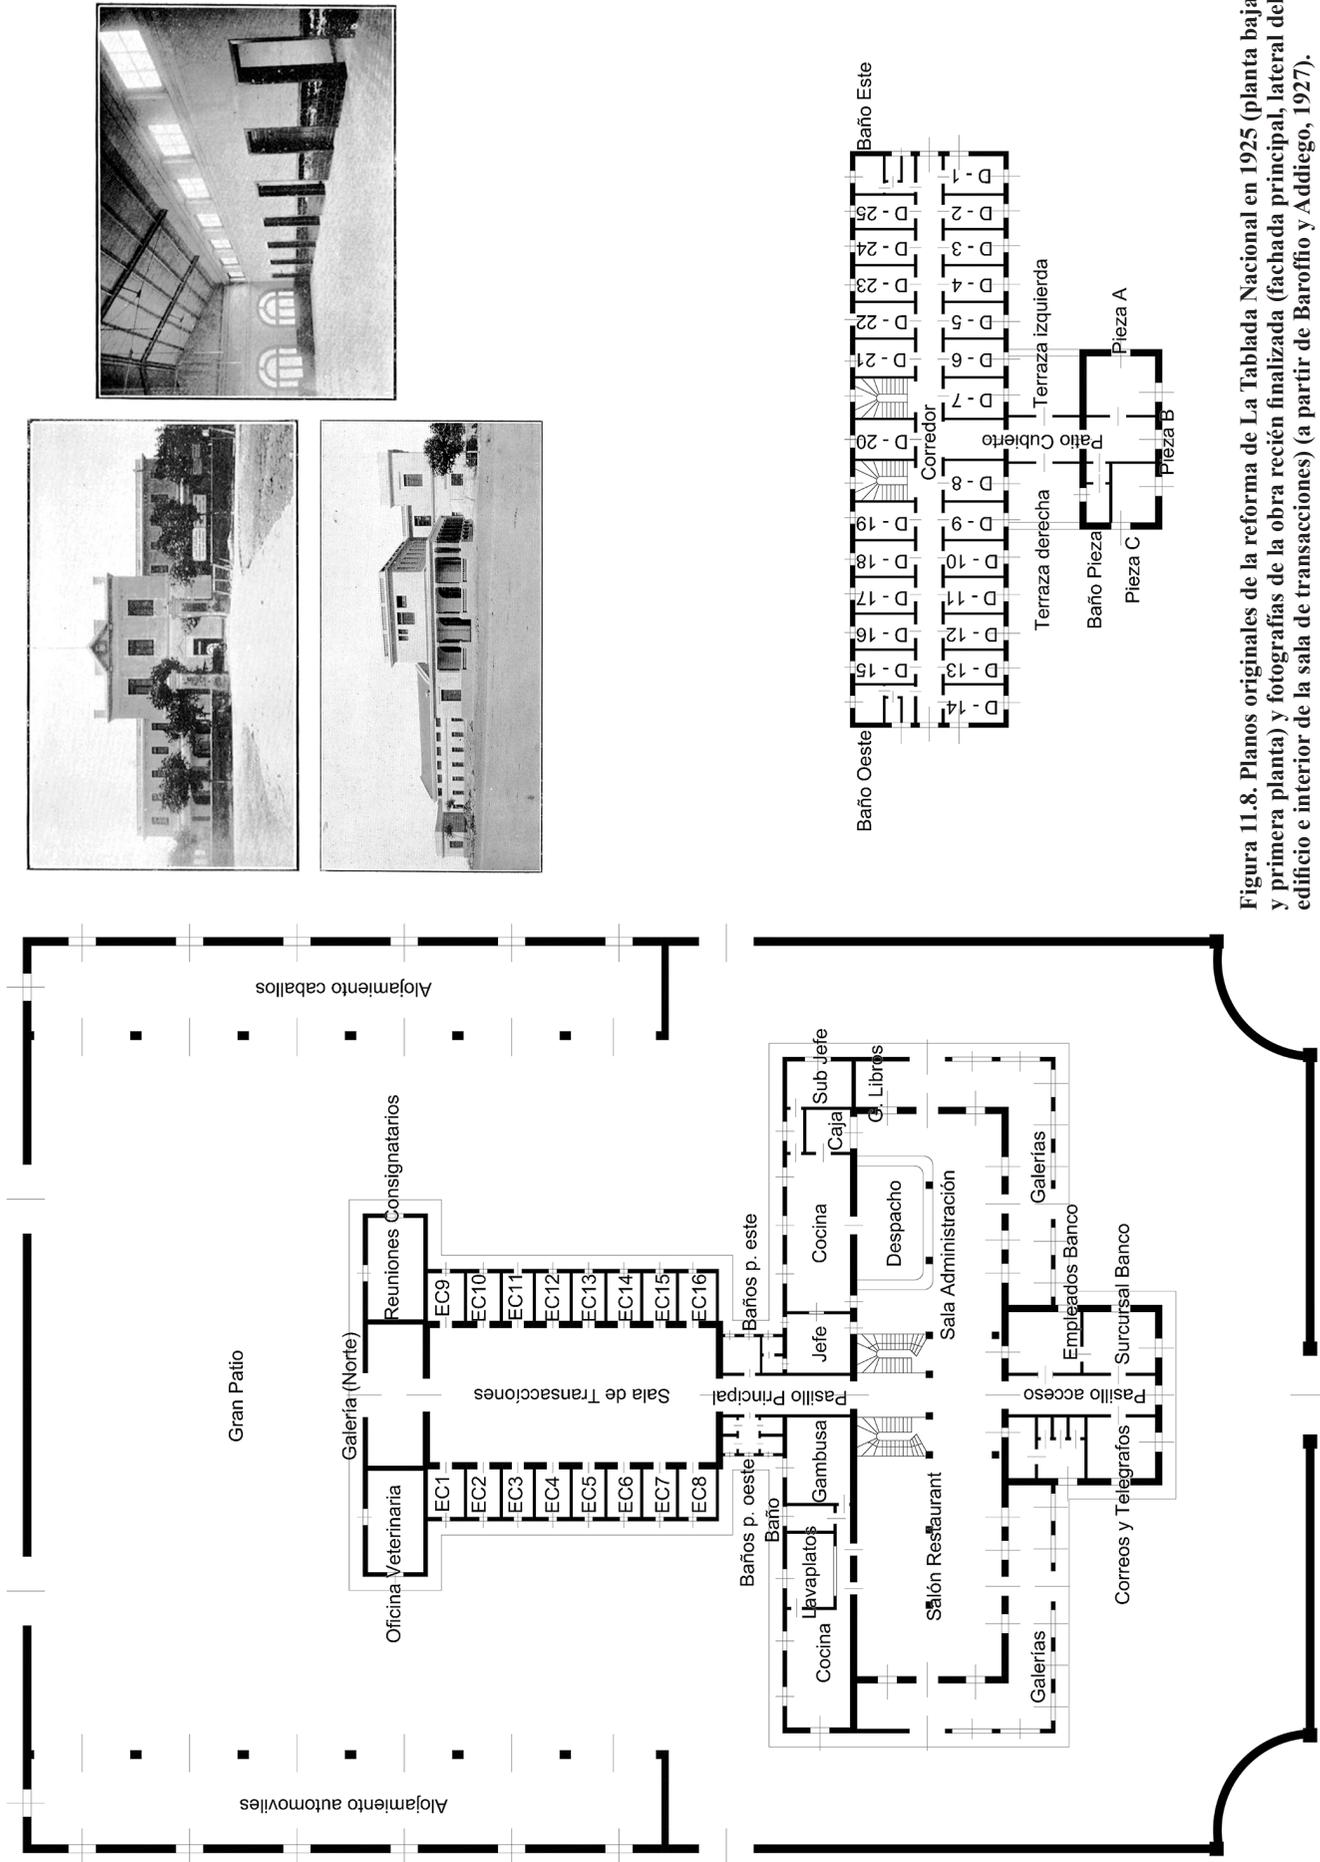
Planos originales de la reforma de La Tabladora Nacional en 1925 (planta baja y primera planta) y fotografías de la obra recién finalizada (fachada principal, lateral del edificio e interior de la sala de transacciones) (a partir de Baroffio y Addiego, 1927).
